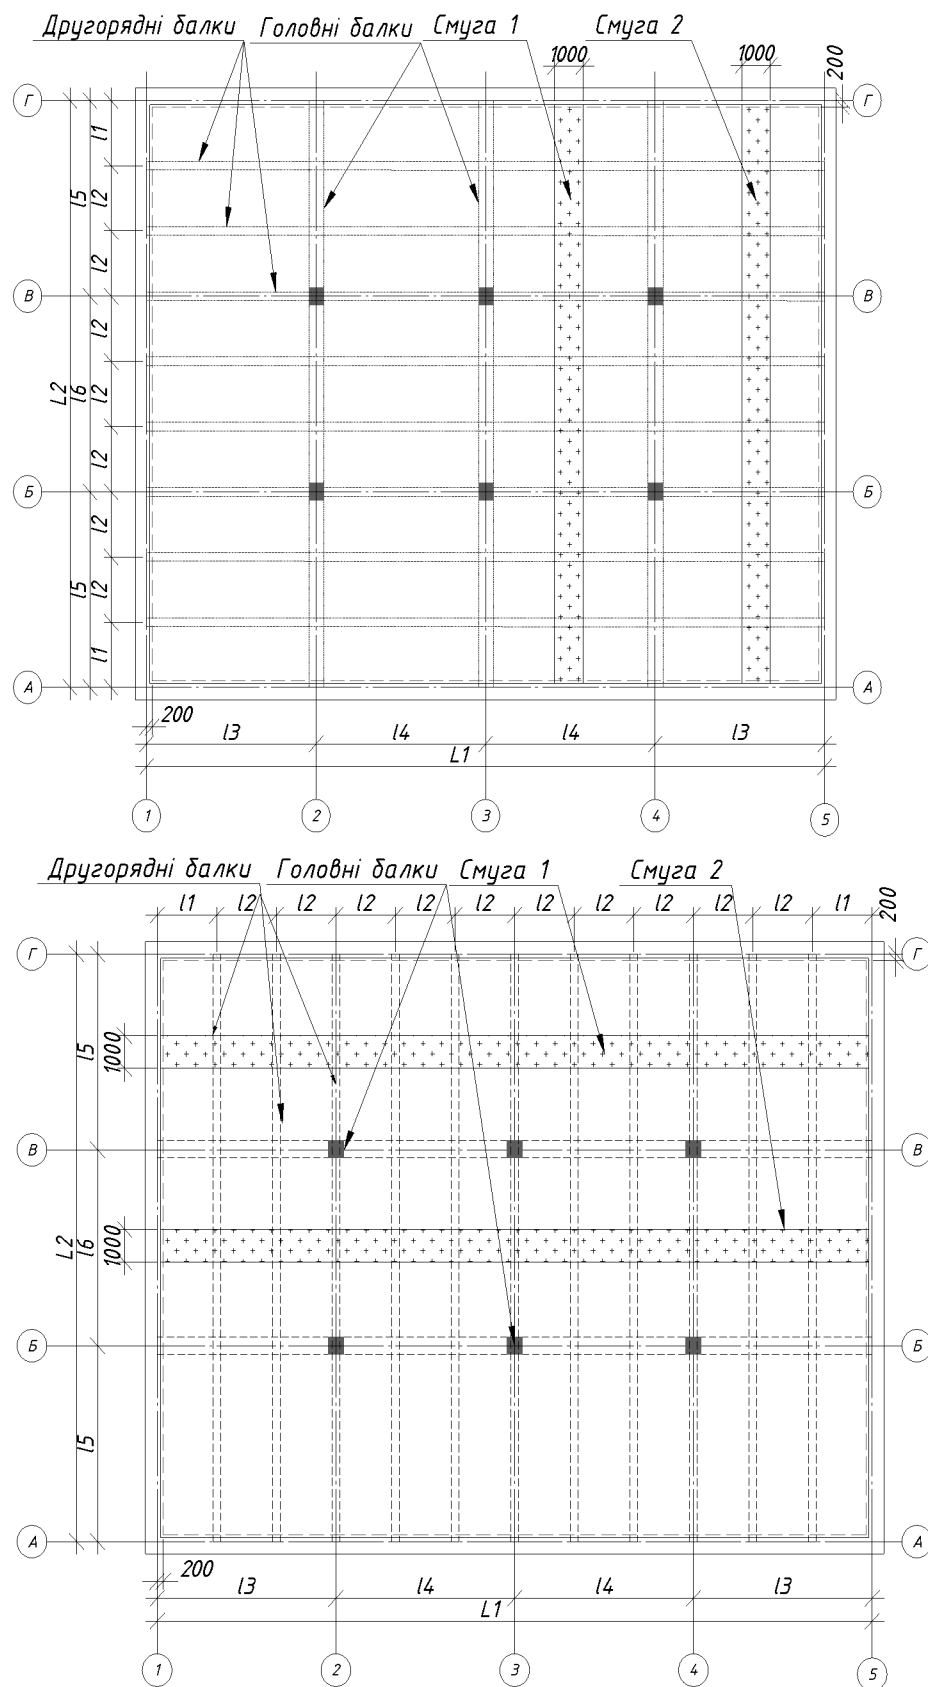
Конструктивна схема перекриття з поперечним та повздовжнім розташуванням головних балок.
